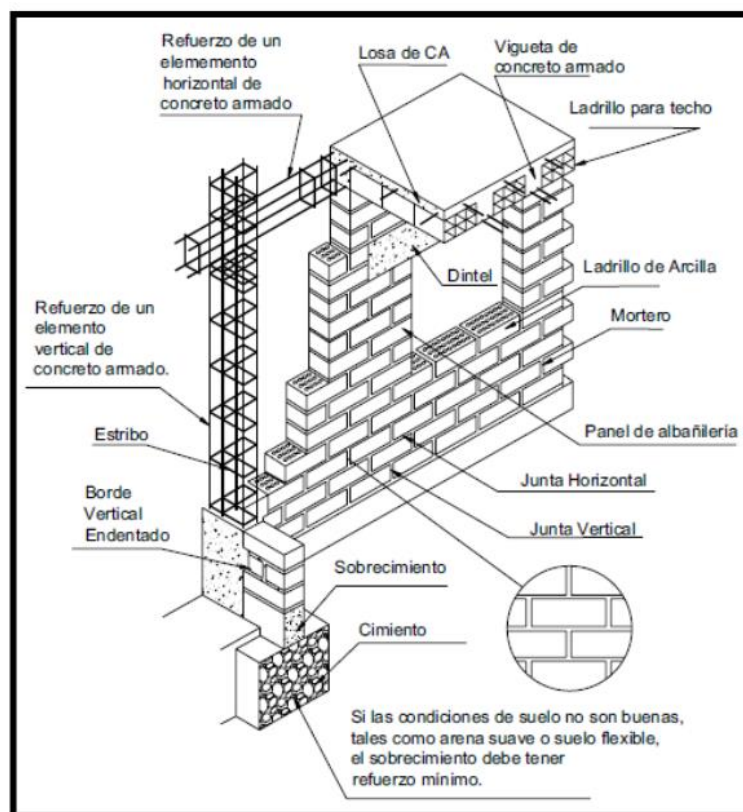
Esquema estructural de albañilería confinada (UNI, 2004)
